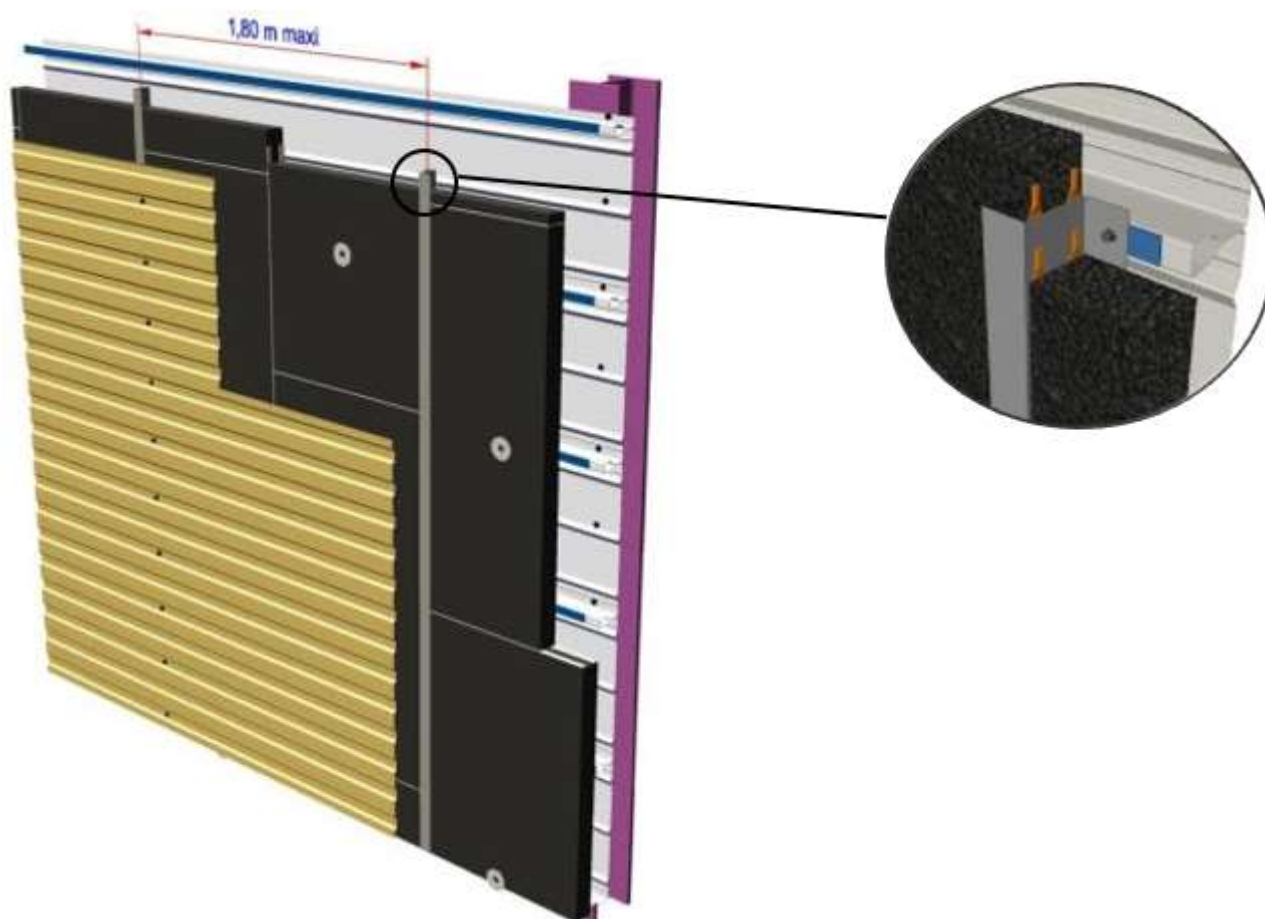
Vue en perspective avec détail (exemple : plateaux horizontaux avec Z à 90° et peau d'étanchéité horizontale)
